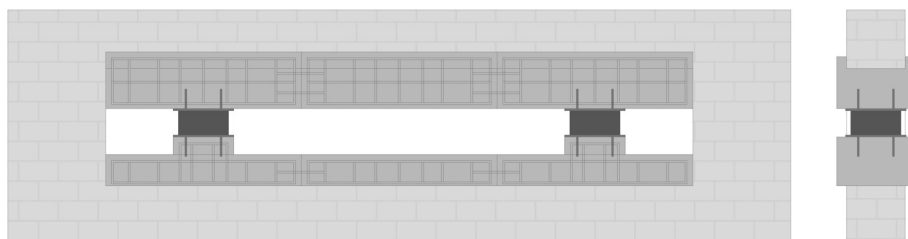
Fase di intervento n.6, apertura muraria tra le installazioni precedenti e collegamento delle armature sotto e sovrastanti
